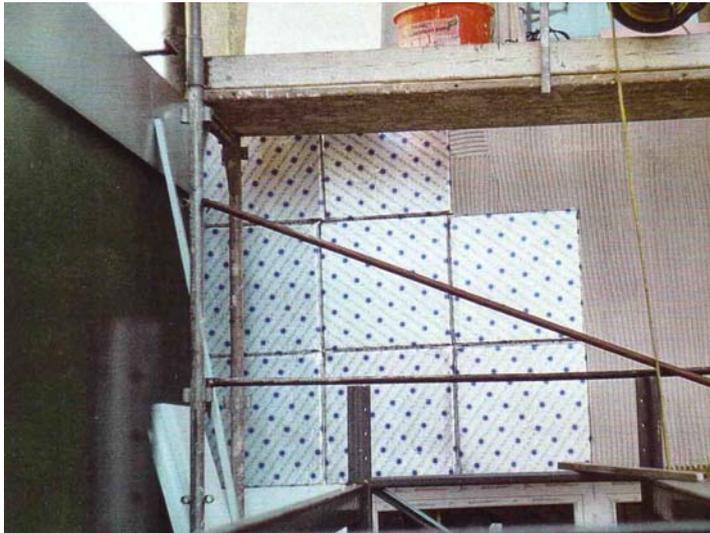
Sandwichwandaufbau an der Fassade Fa. Capatect
